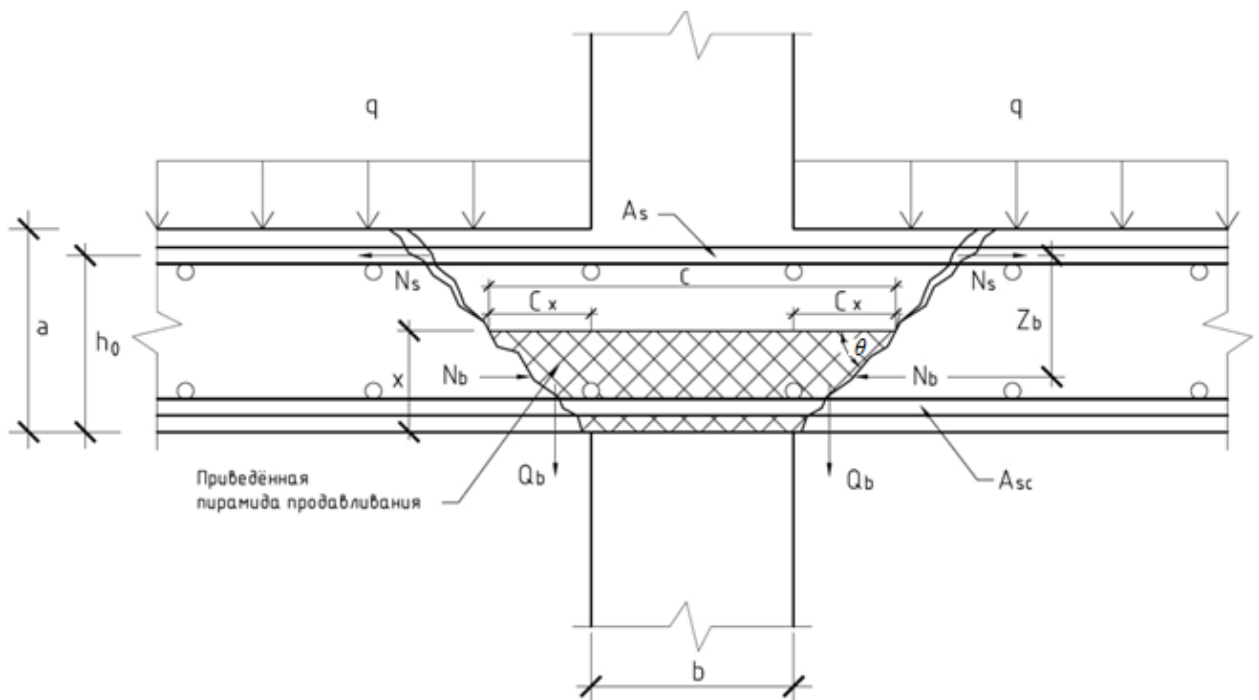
Расчетная схема к определению несущей способности узла сопряжения колонны с перекрытием при продавливании [74,139]
